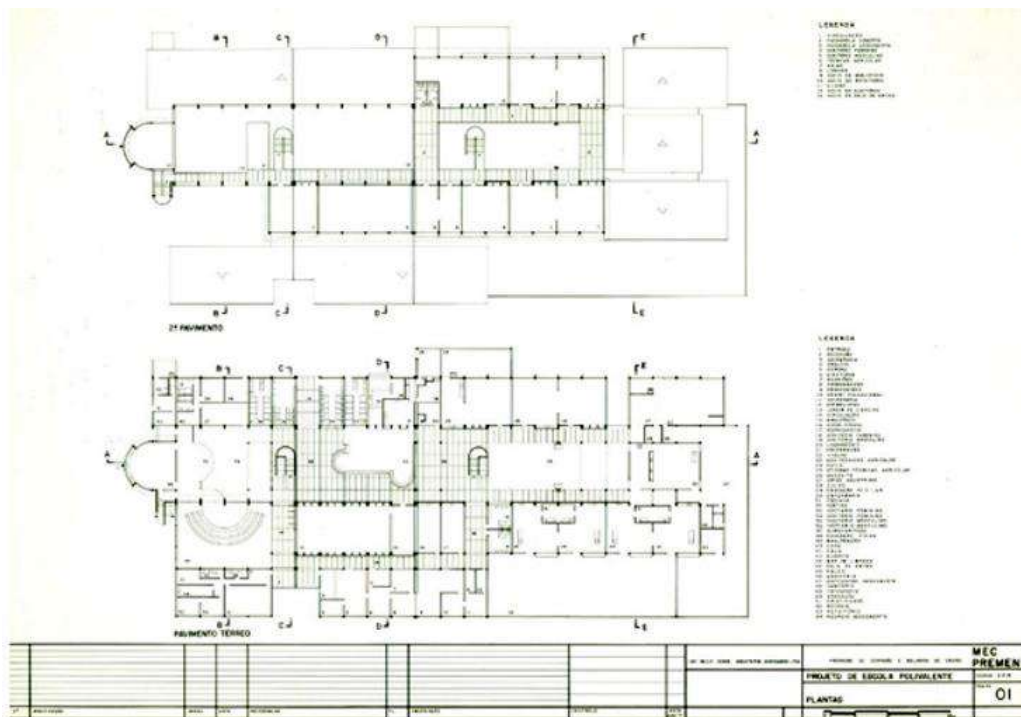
Luiz Paulo Conde. Projeto para Escola Polivalente, 1977. Plantas baixas.
